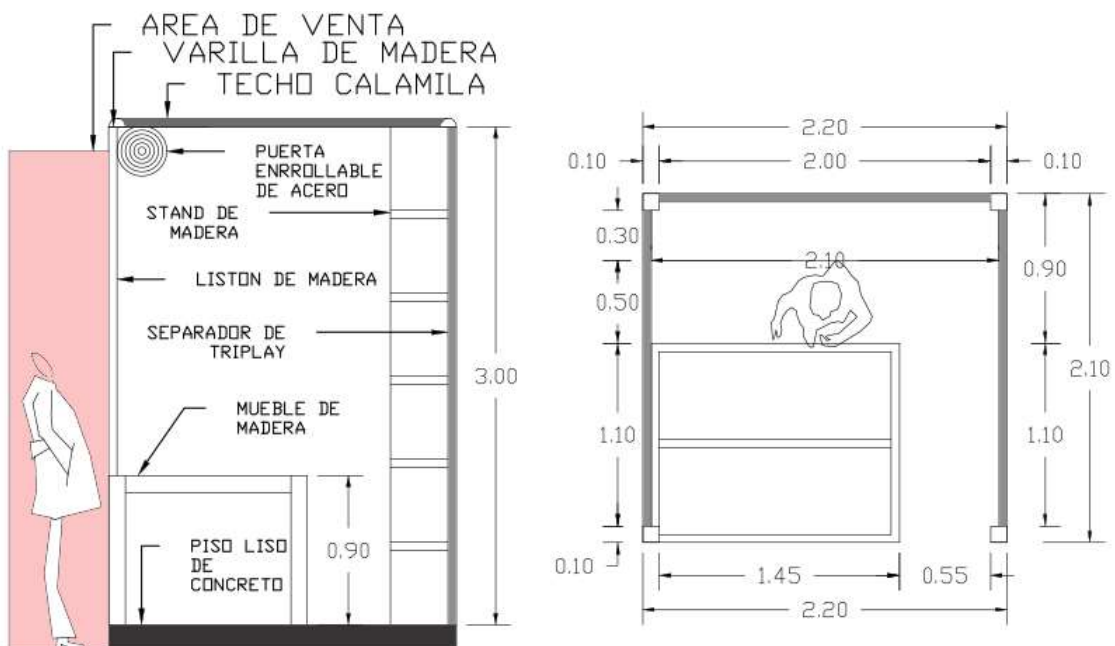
Corte Detallado del Puesto de Confitería y Planta / Elaboración propia
